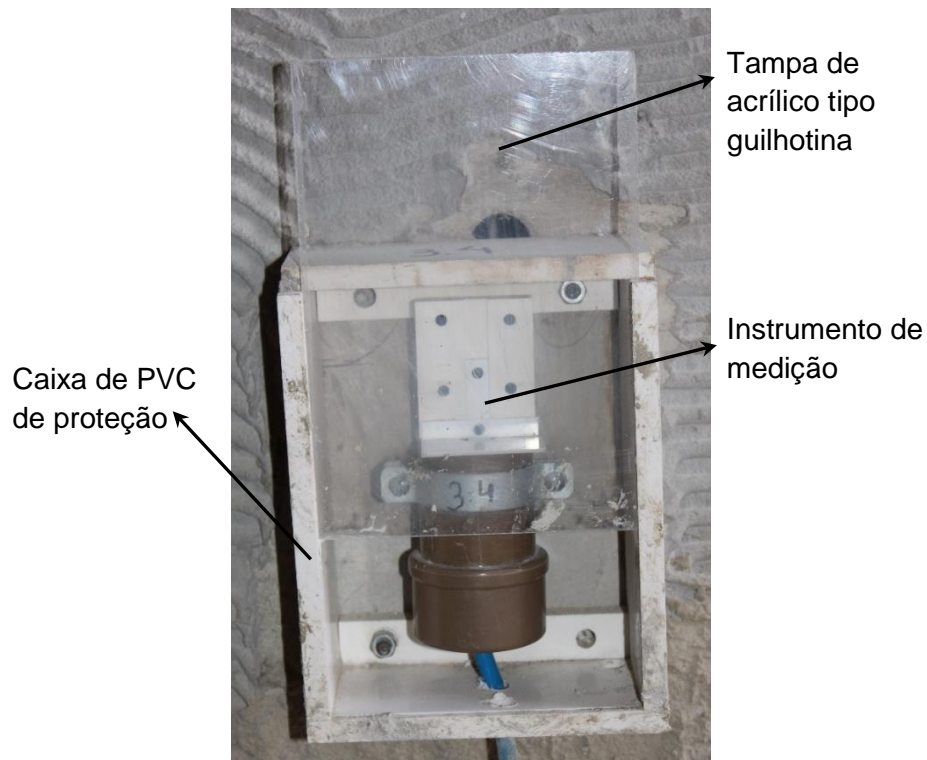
3 - Caixa branca de PVC e tampa removível para proteger o instrumento de medição.
